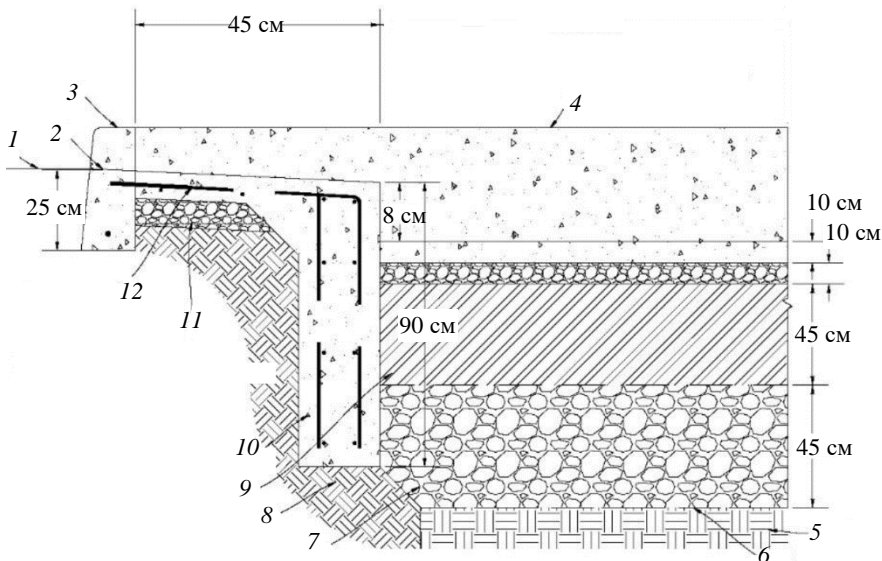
Типовой профиль плантатора при обрезке бордюра:
